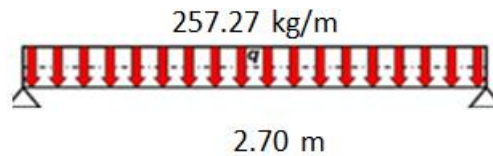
Carga distribuida en la viga eje 1 entre a-b
